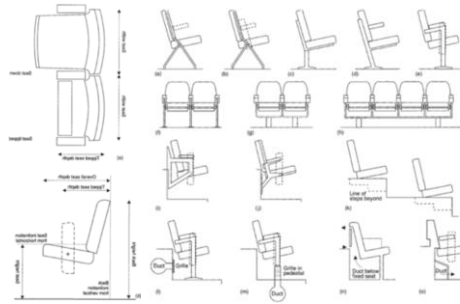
13. Layout Tempat Duduk pada Auditorium 1
